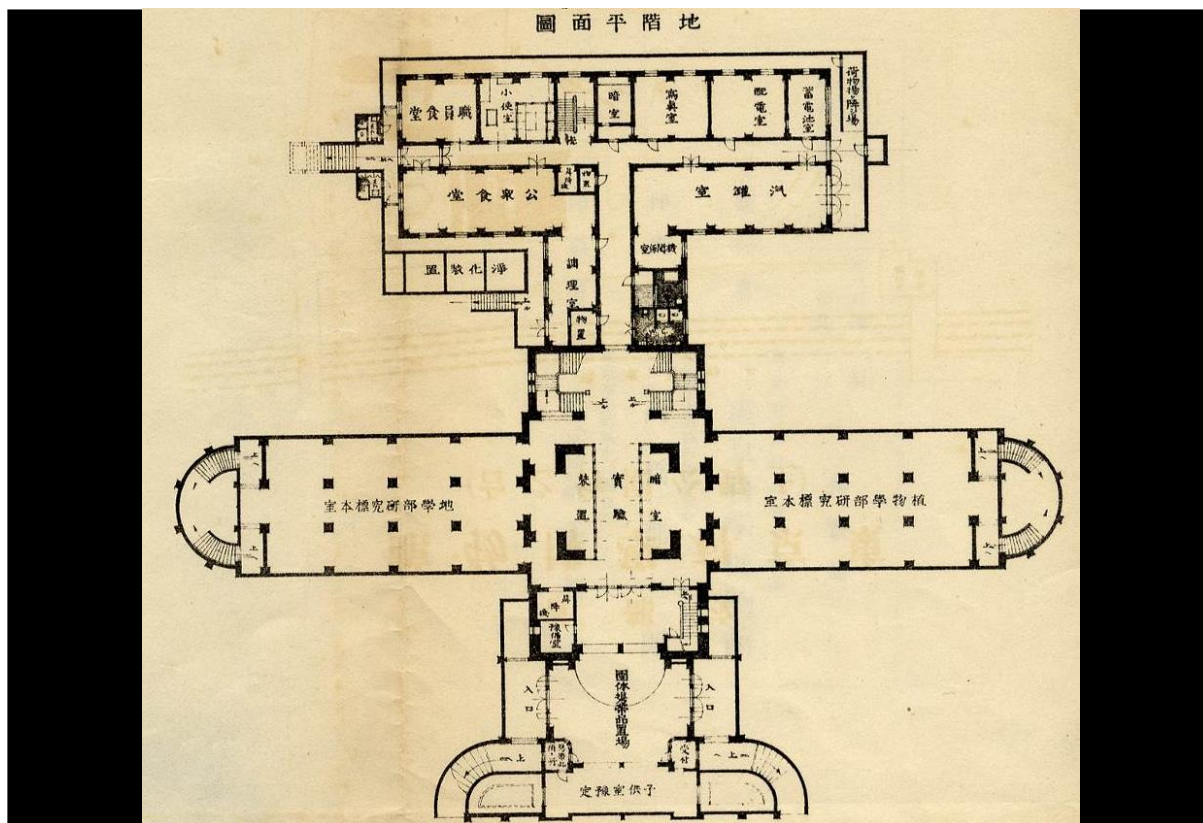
東京博物館復興建築設計圖（部分 地階平面図）
